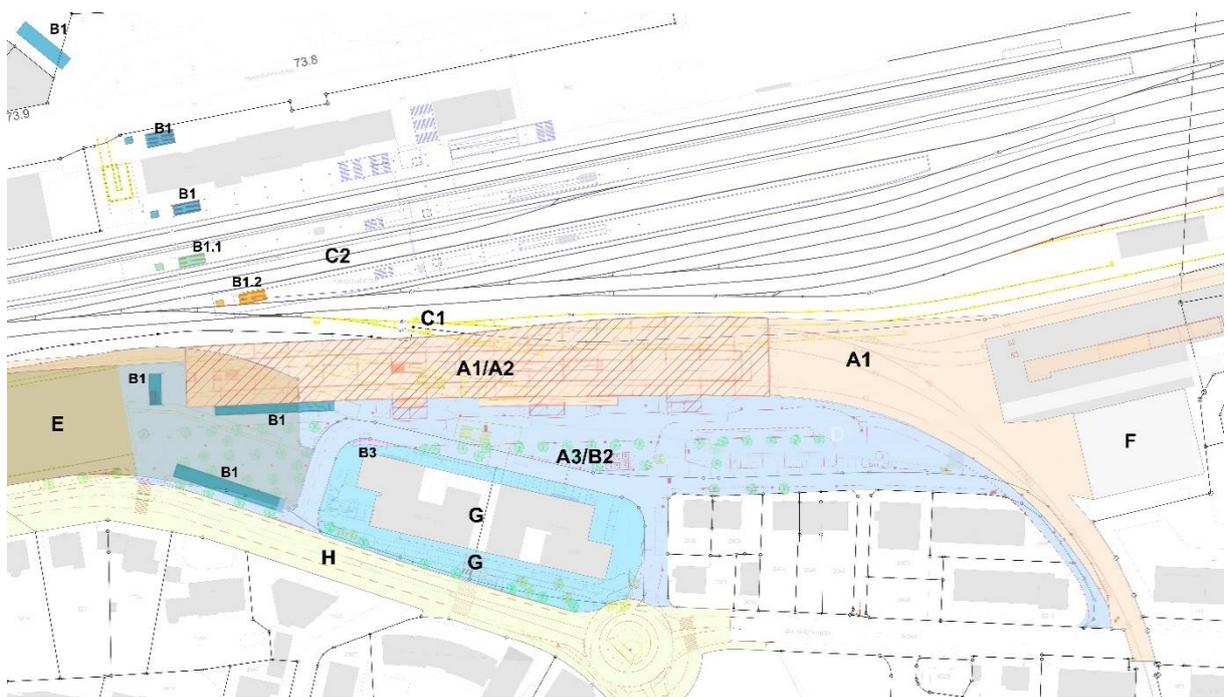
; Planausschnitt Situation auf Ebene Erdgeschoss mit Darstellung der Module
